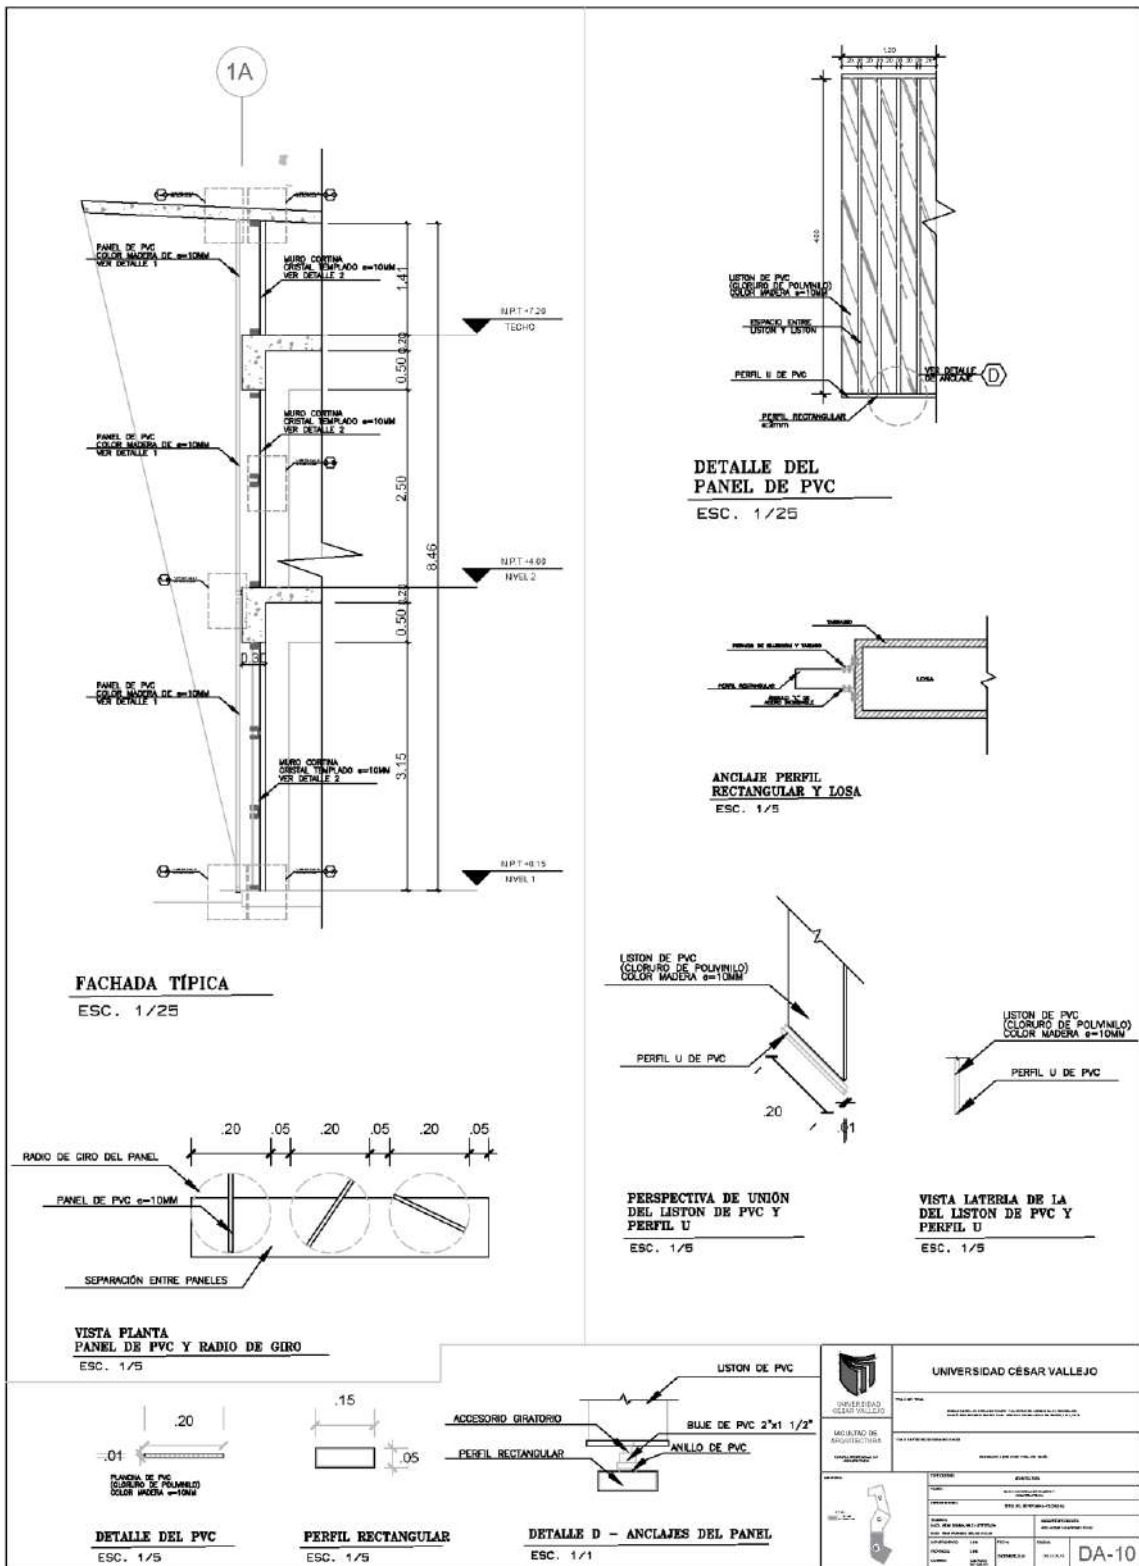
Detalle de fachada - DETALLES ARQUITECTÓNICOS
